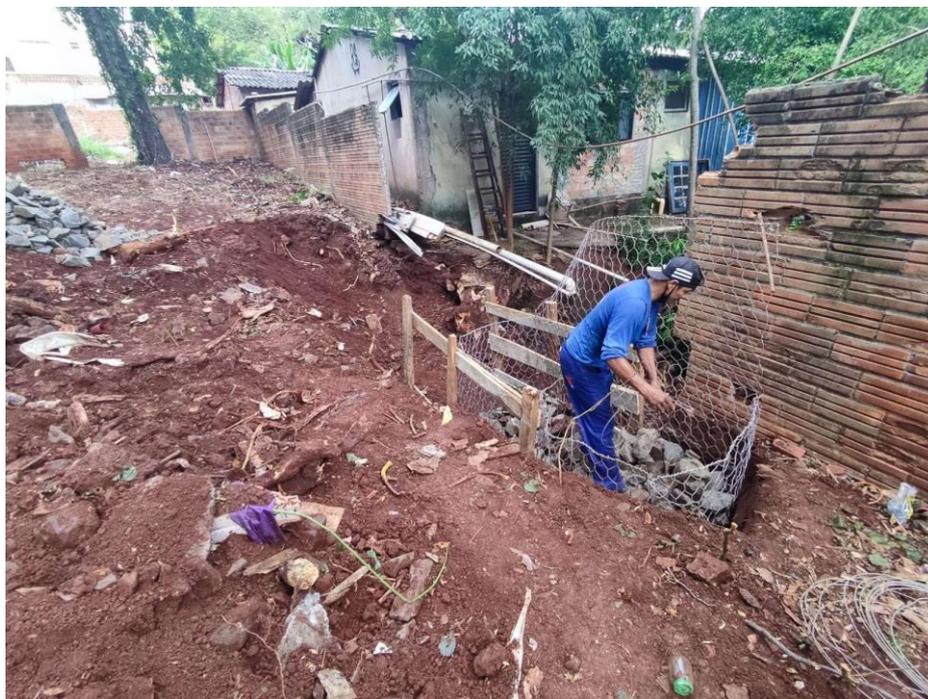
OBRA DE RECONSTRUÇÃO DO MURO DE DIVISA.
